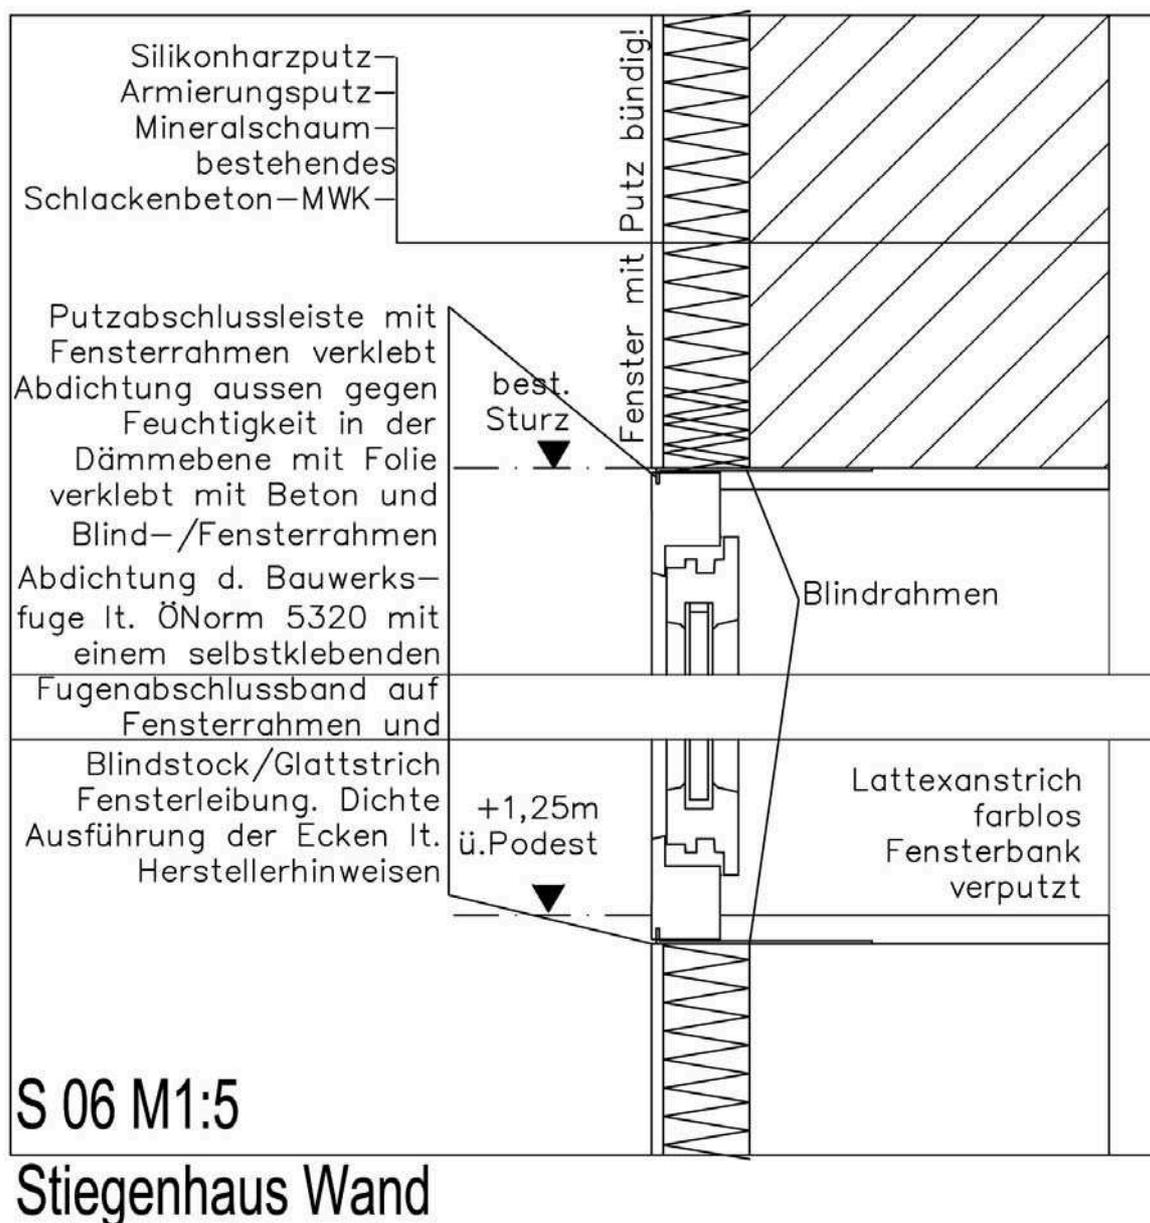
Detail S 06 Vertikaler Fensteranschluss Stiegenhaus
